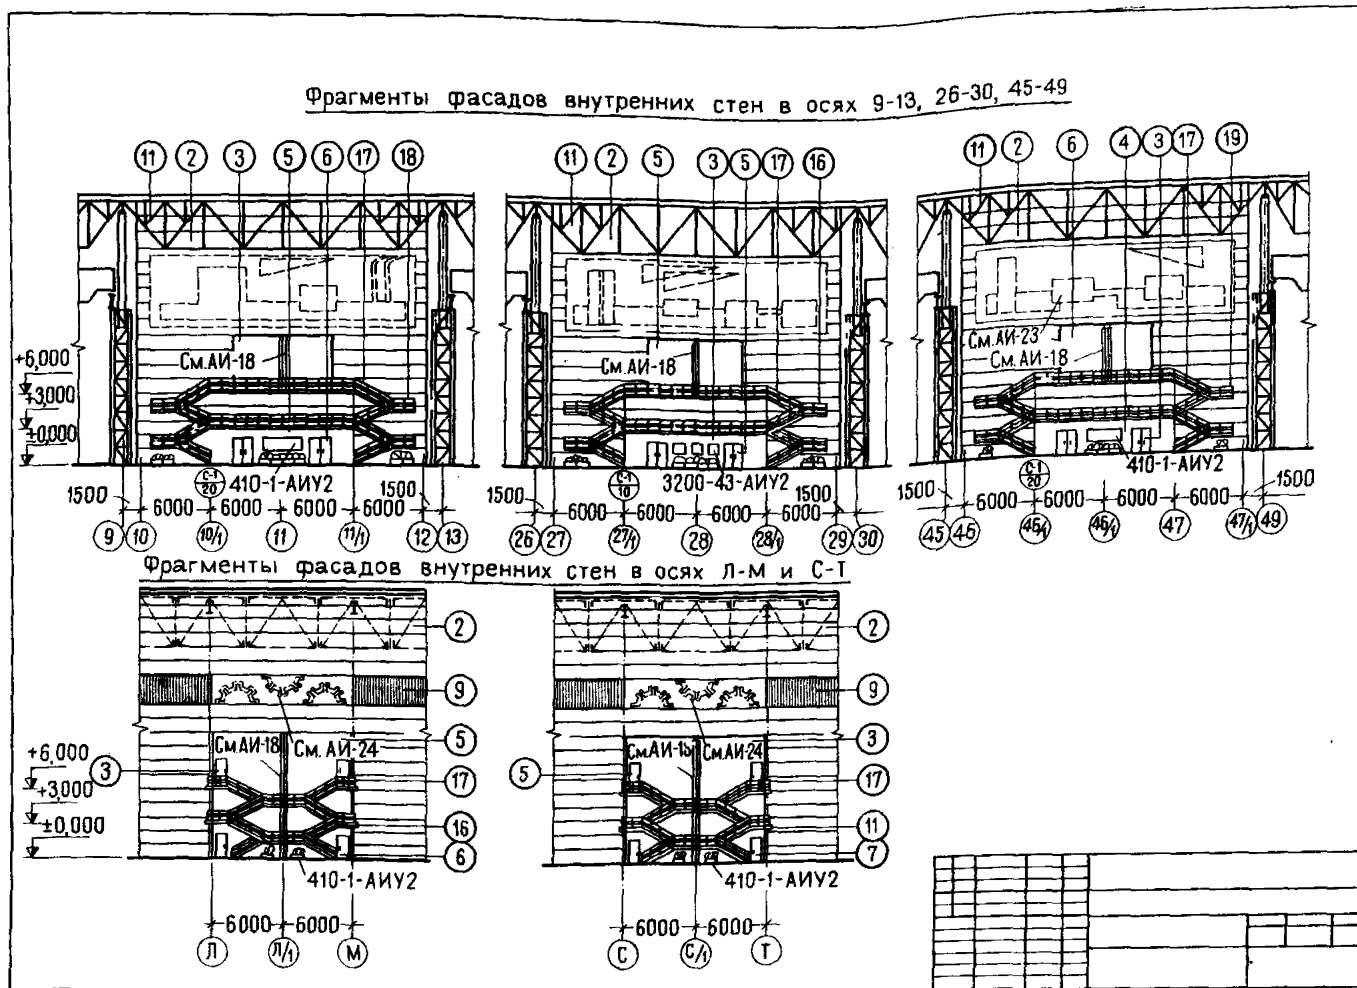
Пример выполнения рабочего чертежа фрагментов фасадов внутренних стен марки АИ
